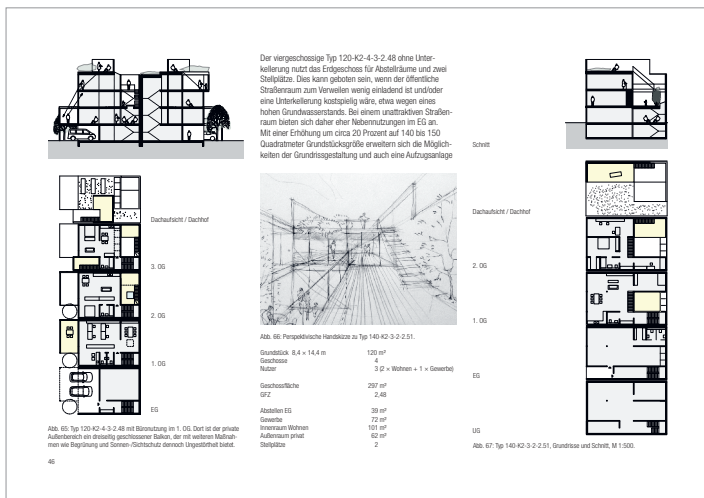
Typ 140-K2-3-2-2-62: Grundriss und Schnitt, M 1:500.
